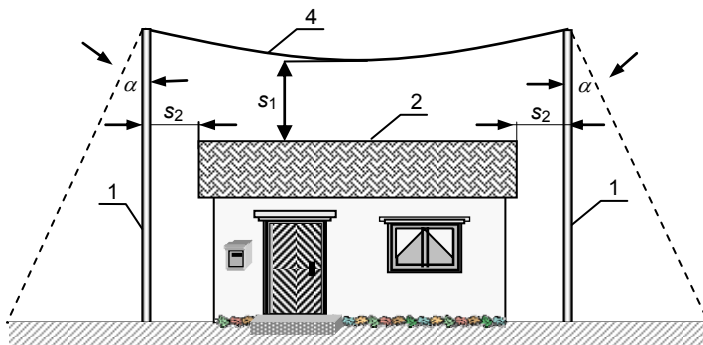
Projection sur un plan vertical parallèle à celui contenant deux mâts
